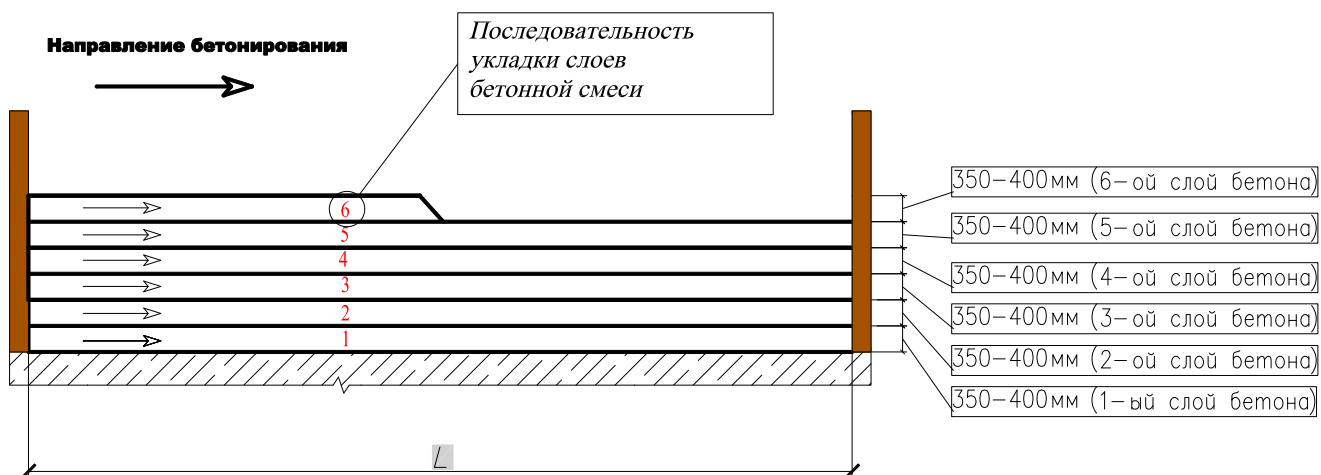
Схема послойной укладки бетонной смеси в конструкцию стен
